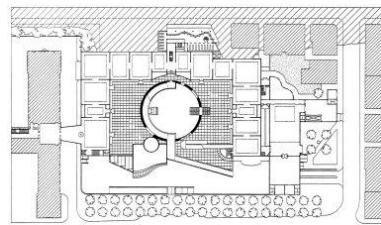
Ampliação da Staatsgalerie, Stuttgart, 1977, J. Stirling (Planta)
